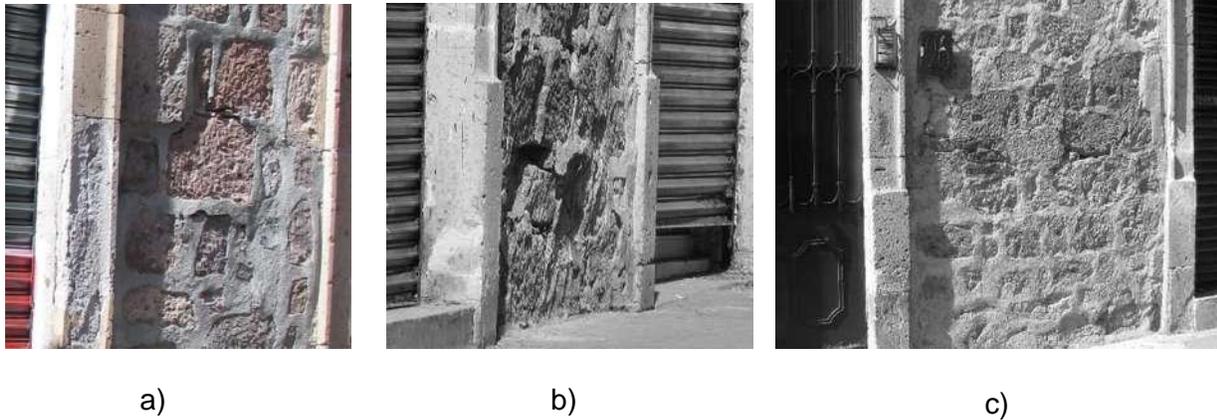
a) Fachada oriente. Foto: CEC. b) Fachada oriente. Foto: CEC. c) Fachada oriente. Foto: CEC
